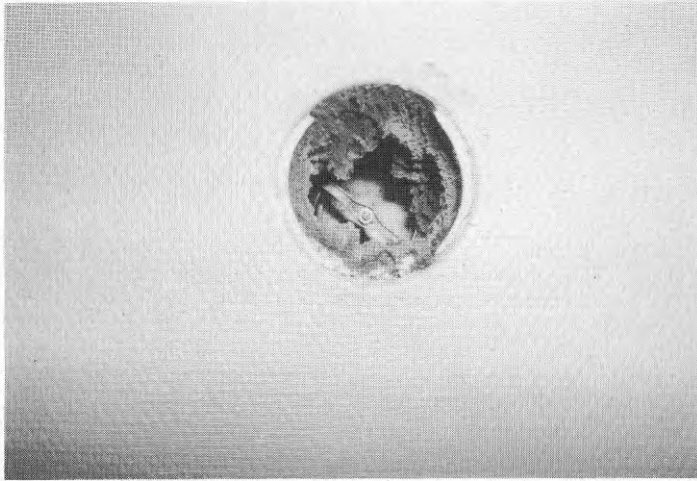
Frånluftsanslutning i badrum i flerbostadshus, Ø 90 mm.
